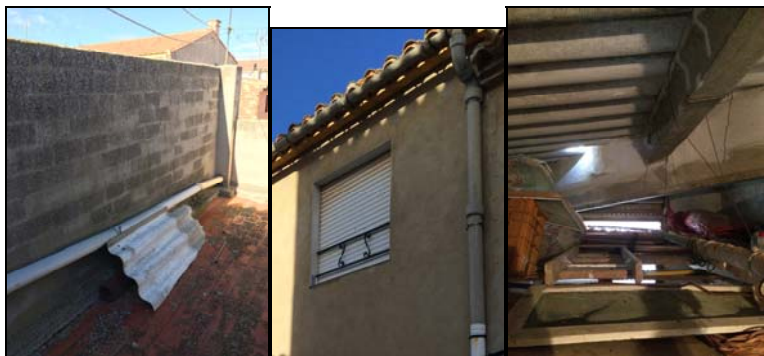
Elementos de fibrocemento que contienen amianto de la vivienda. Fuente propia.
